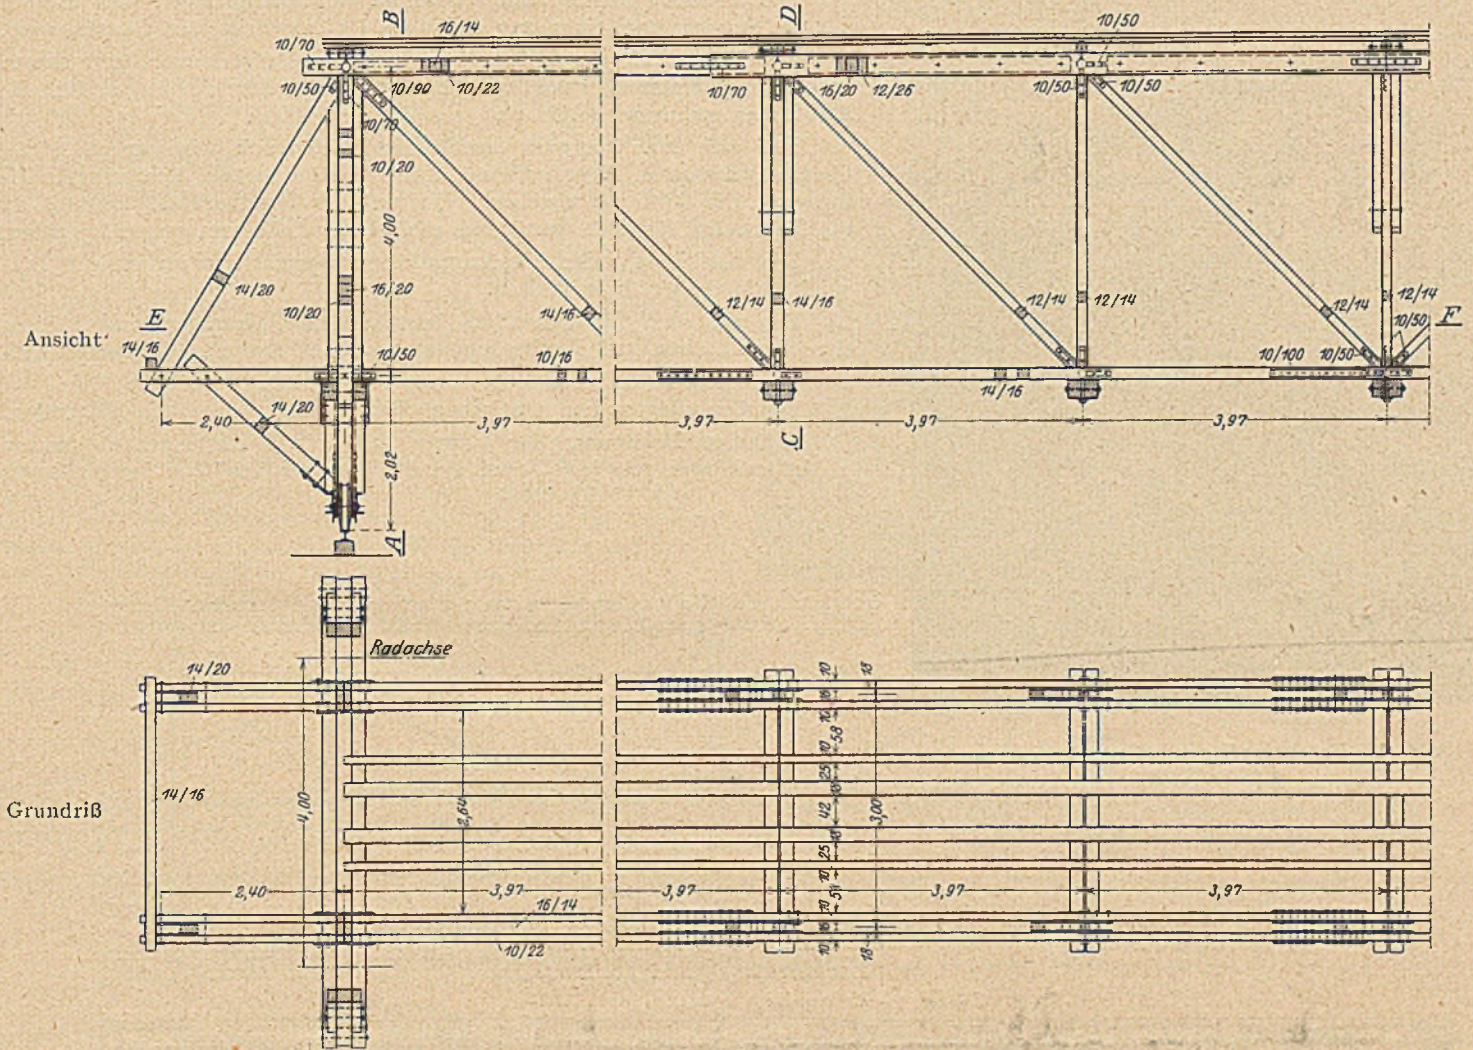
Ansicht und Grundriß der Betonierbrücke in Stettin.
